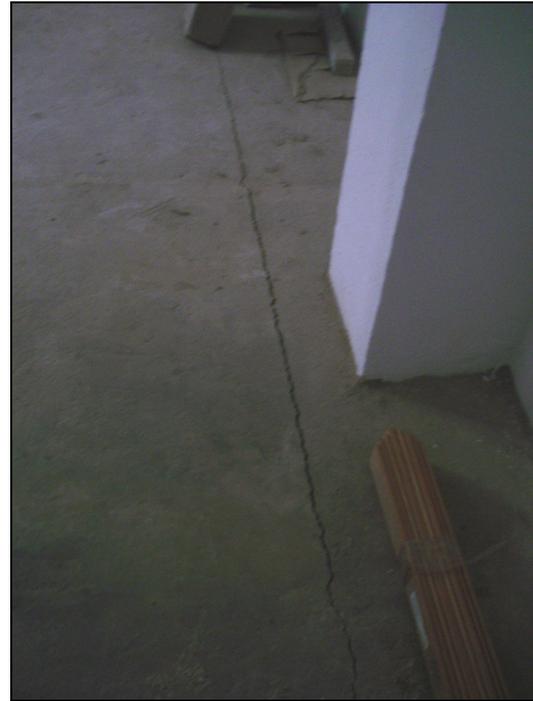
Grieta en planta baja en sentido longitudinal de la casa, de pilar a pilar situados sobre la acequia.
